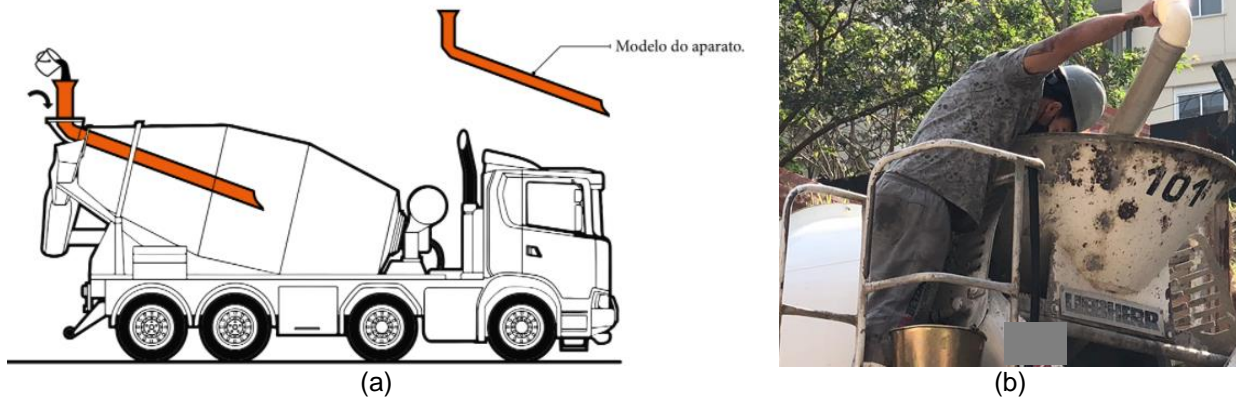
Exemplo de aparato adotado para a adição de aditivo em obra: (a) esquema ilustrativo e (b) utilização em obra (Instituto Brasileiro de Impermeabilização (2021) e Arquivo Desek (2020))
